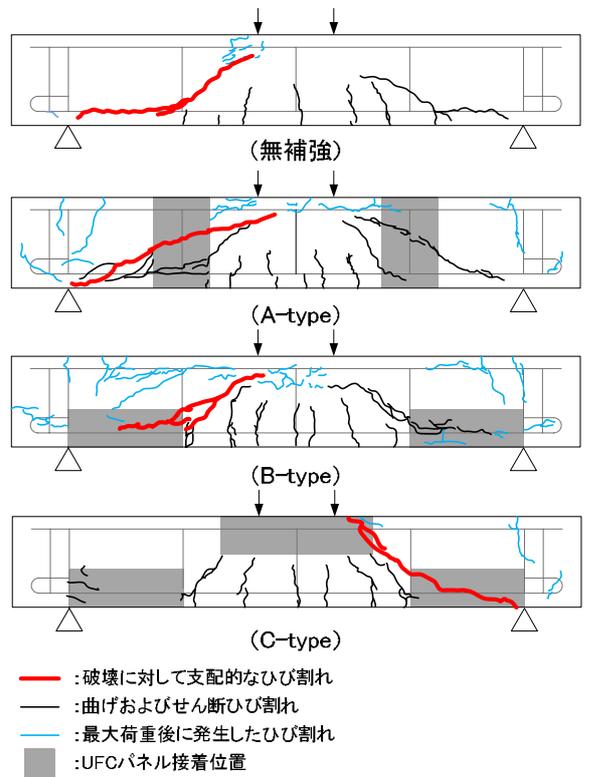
ひび割れ図 (UFC パネル除去後)
